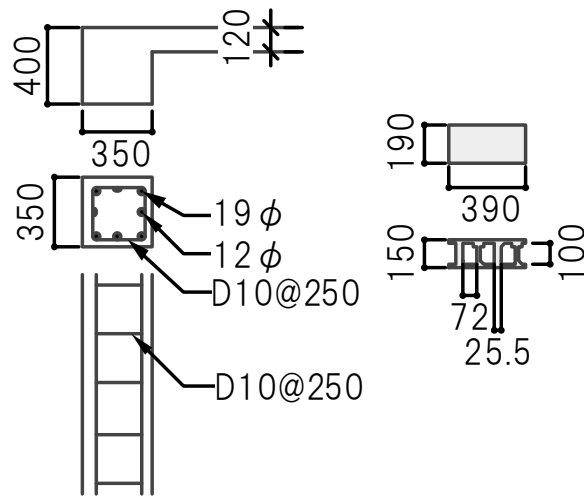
RC 造平屋住宅の柱, CB の寸法図 (単位: mm)
